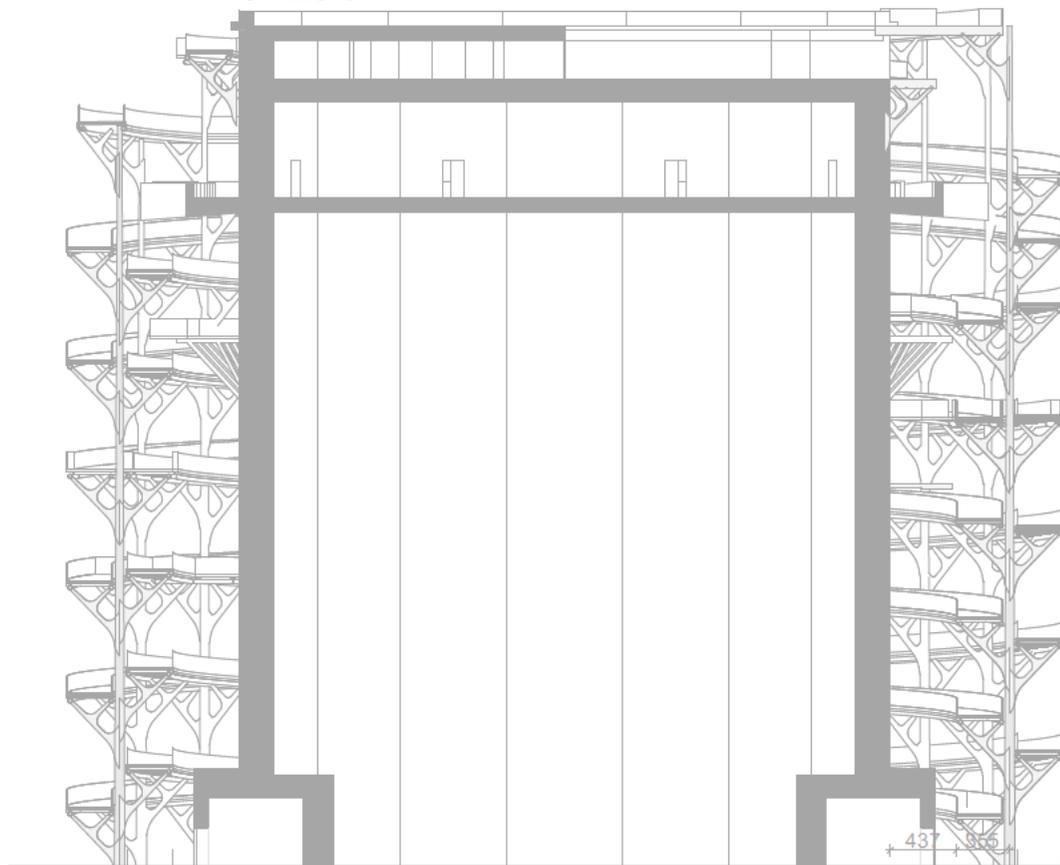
Fassadenschnitt, Konstruktion der Rampe, Skizze 4
